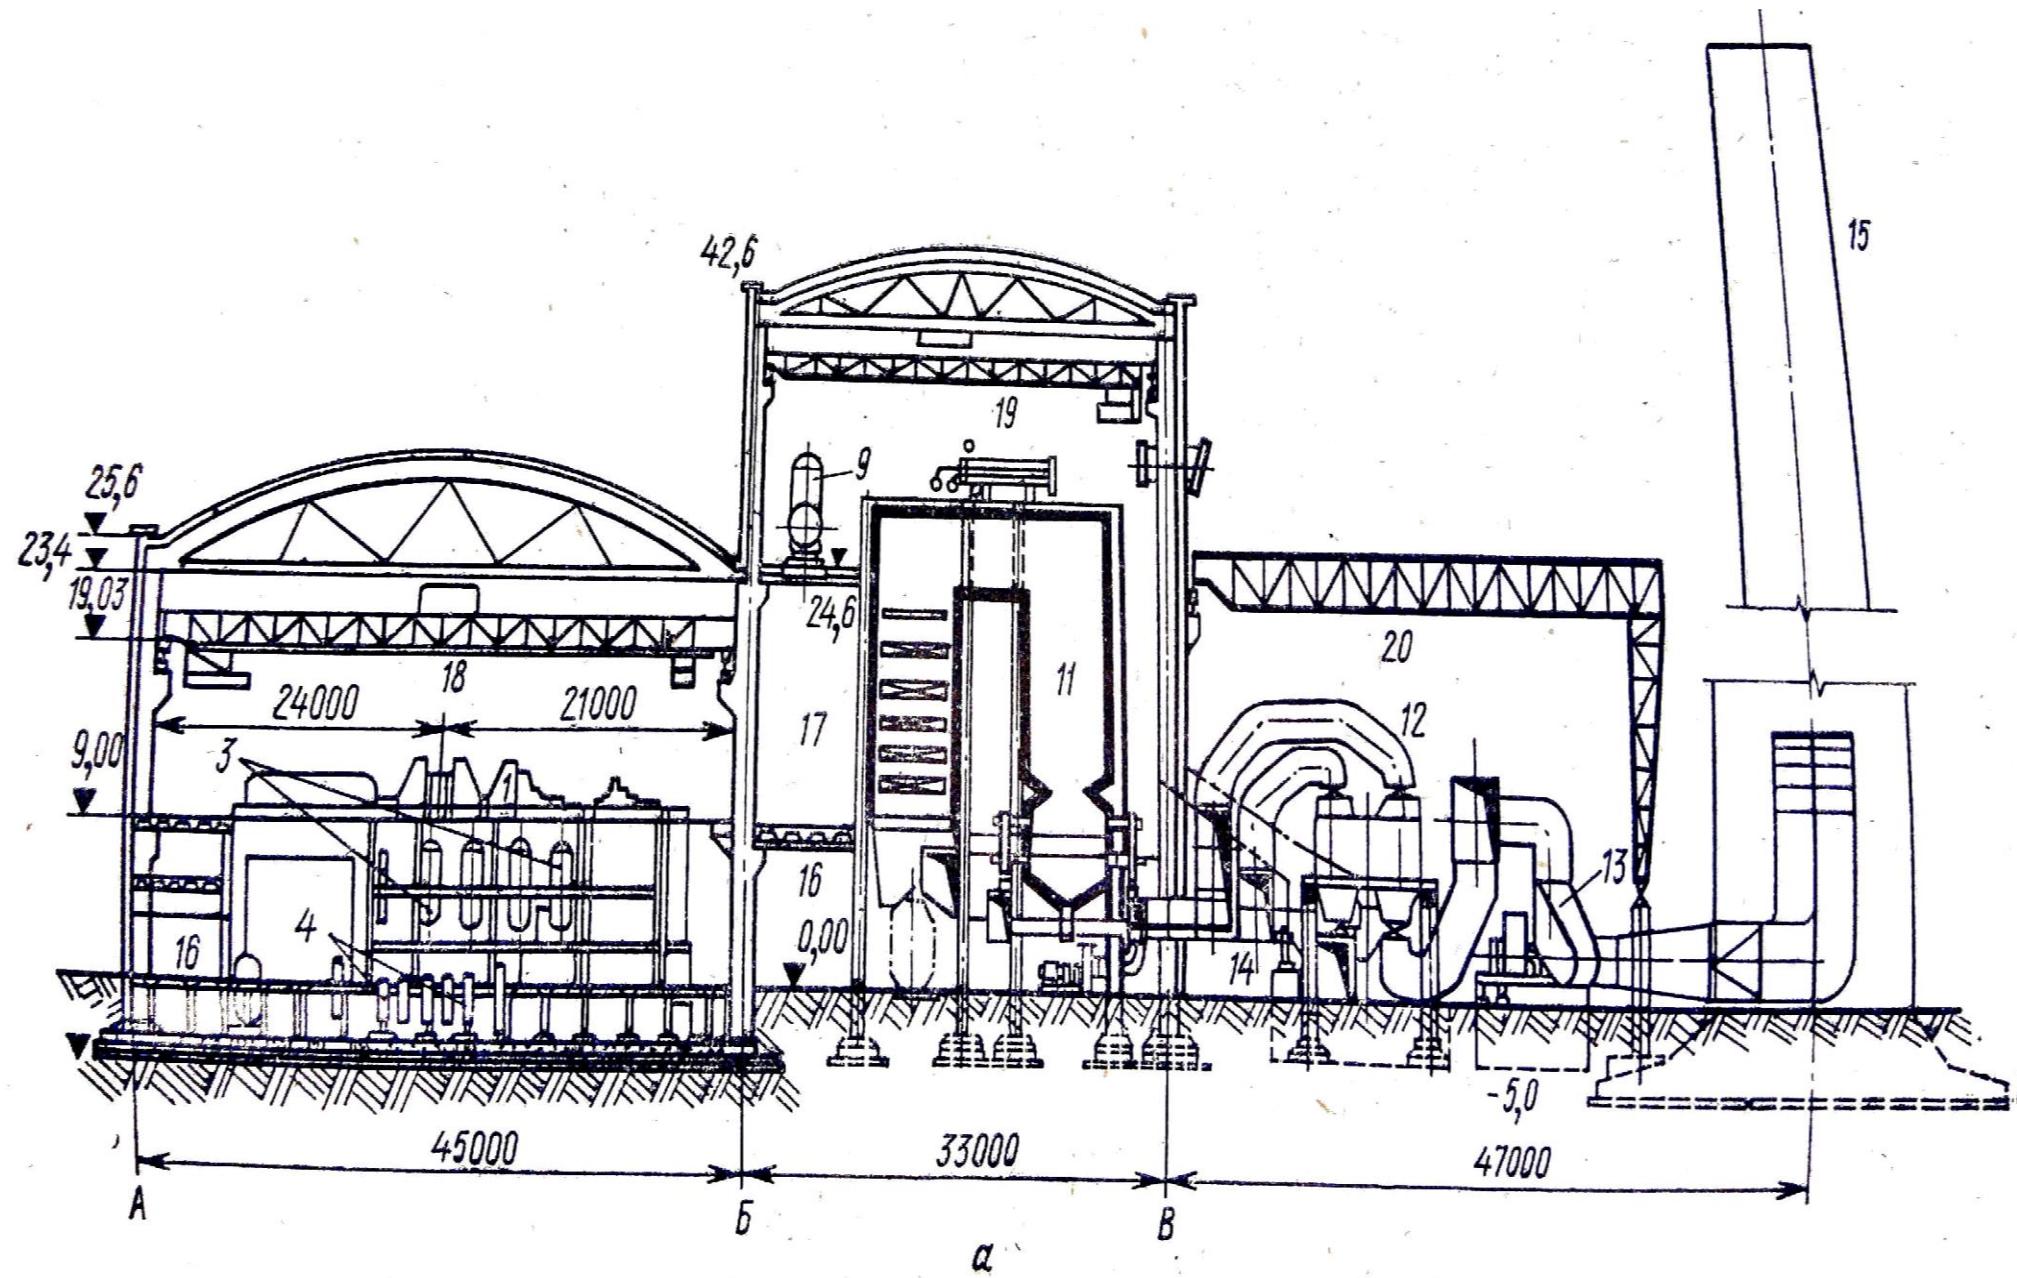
(а) Поперечный разрез универсального главного здания для КЭС с блоками 300МВТ на газомазутном топливе
